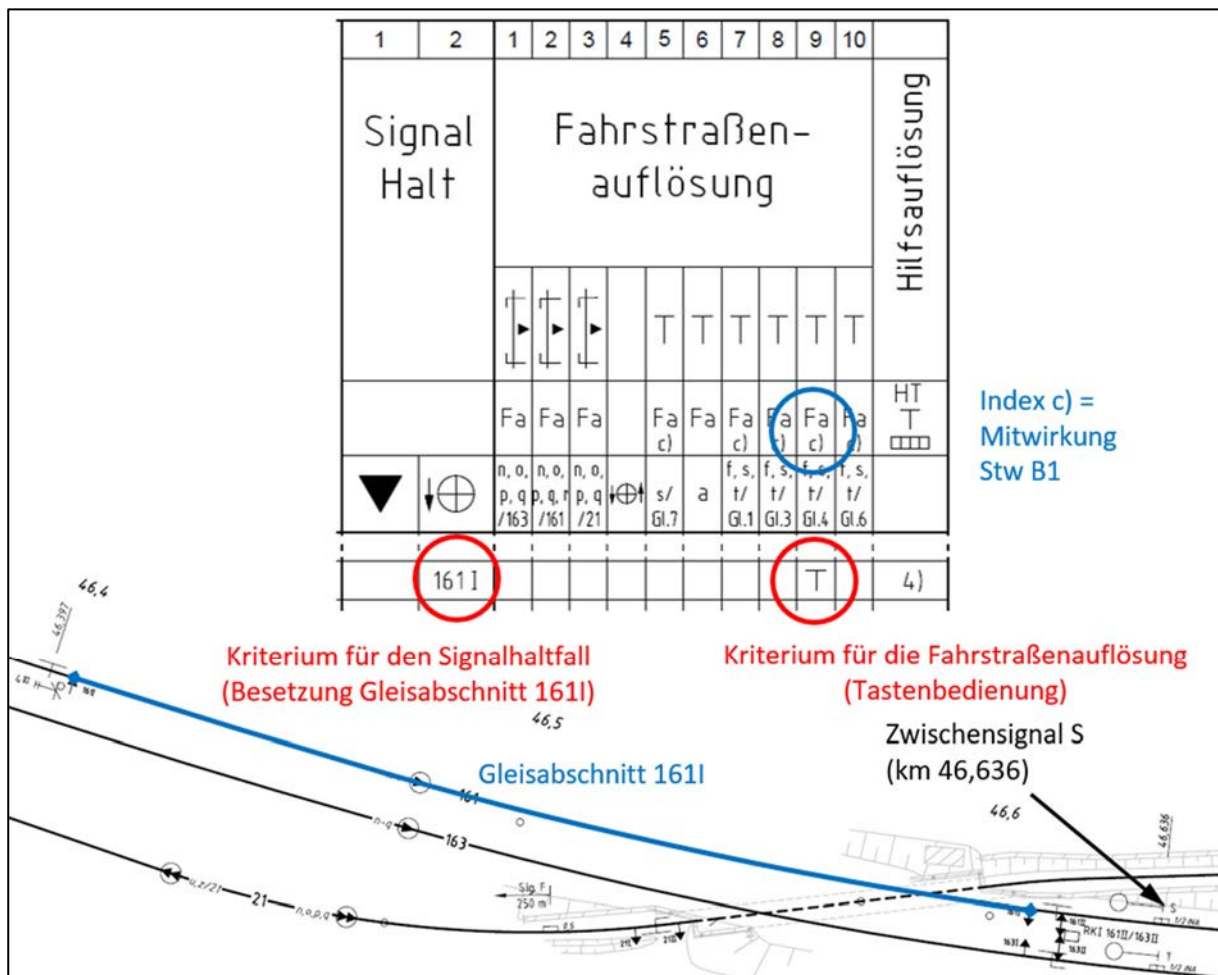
Auszug aus sicherungstechnischem Lageplan und Detaildarstellung aus Verschlussplan Stw W2⁹
